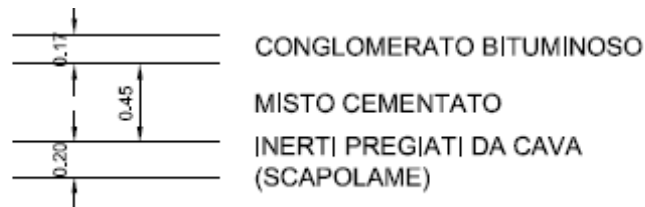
Caratteristiche delle pavimentazioni stradali
